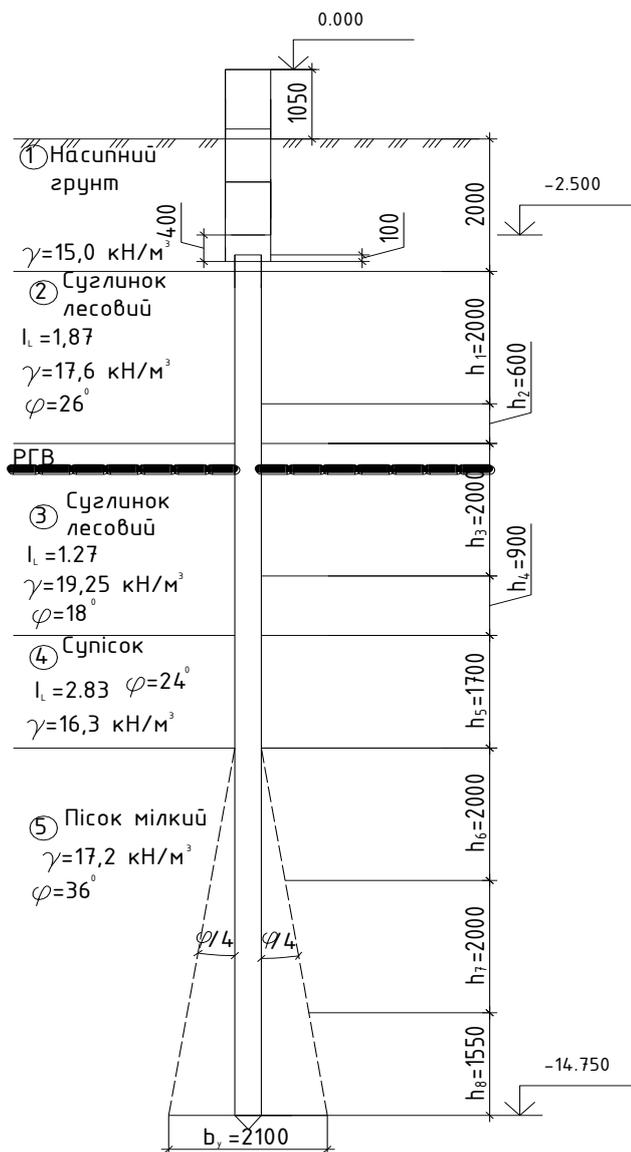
Схема до розрахунку пальового фундаменту під стіну
